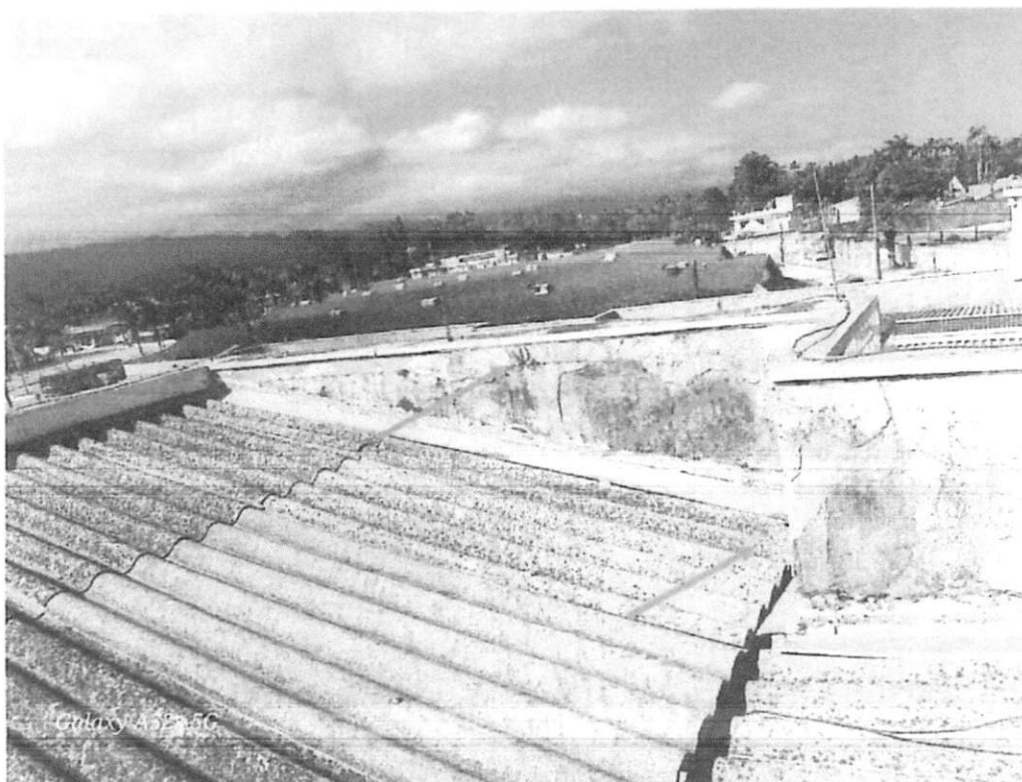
Alvenaria com fissuras e em processo de degradação.
